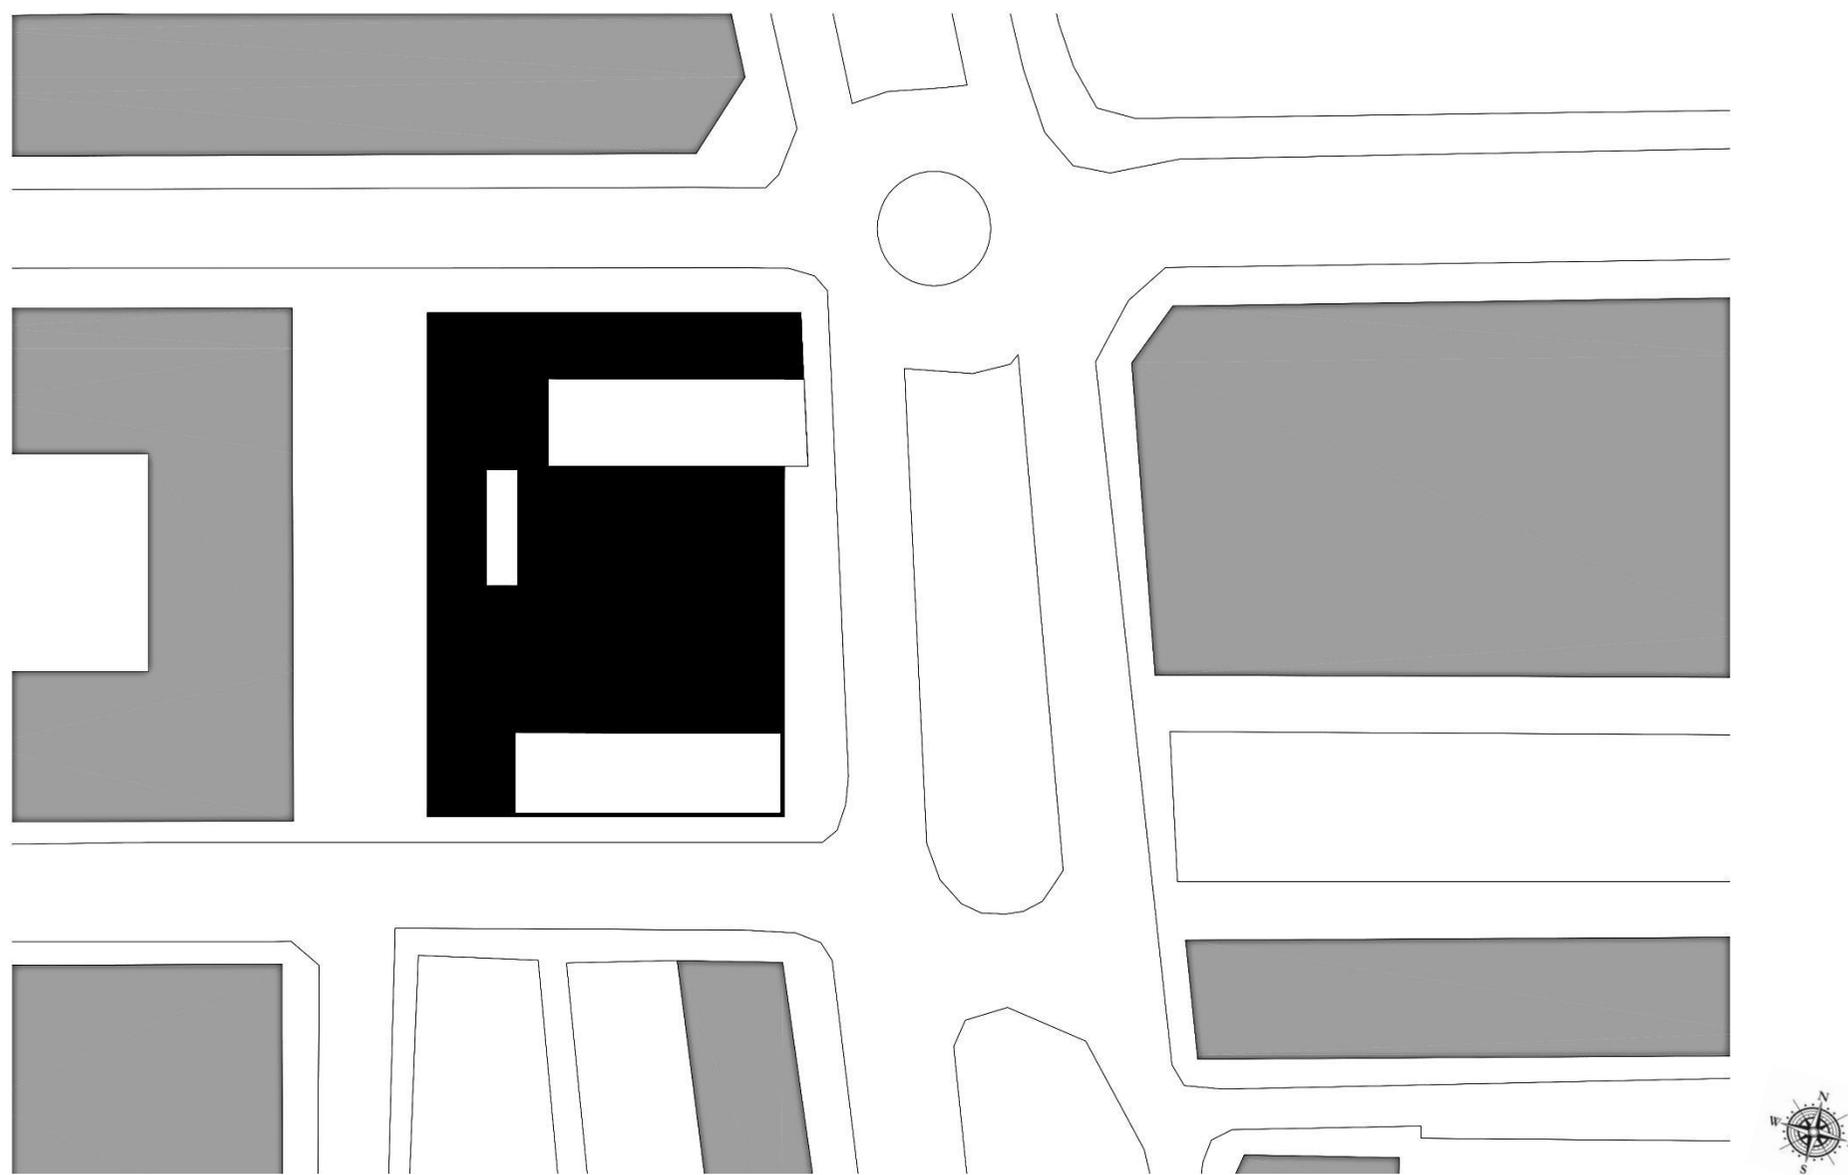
Plano de situación de la Escuela Infantil "La Rambleta"
